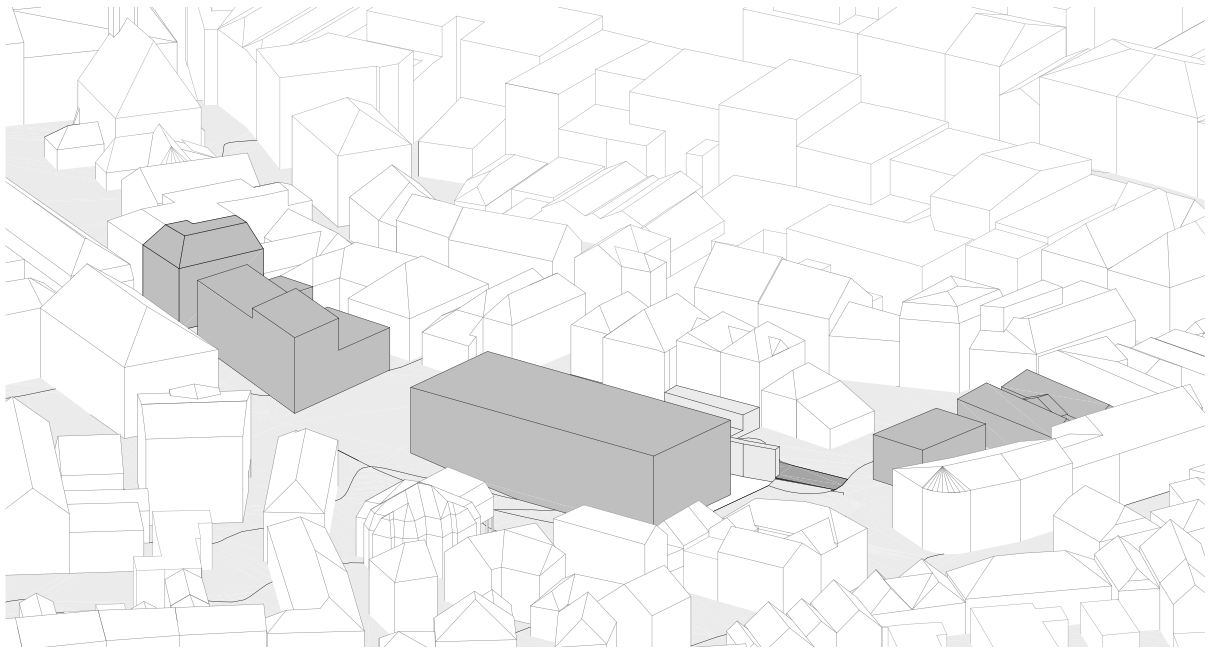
| Iso-Darstellung der städtebaulichen/räumlichen Struktur mit den neuen Interventionen.
